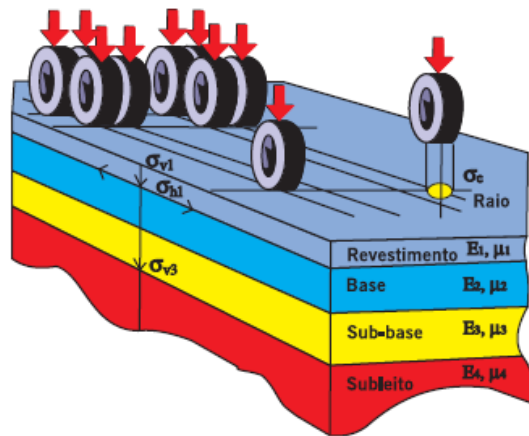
Sistema de camadas de um pavimento e tensões solicitantes
